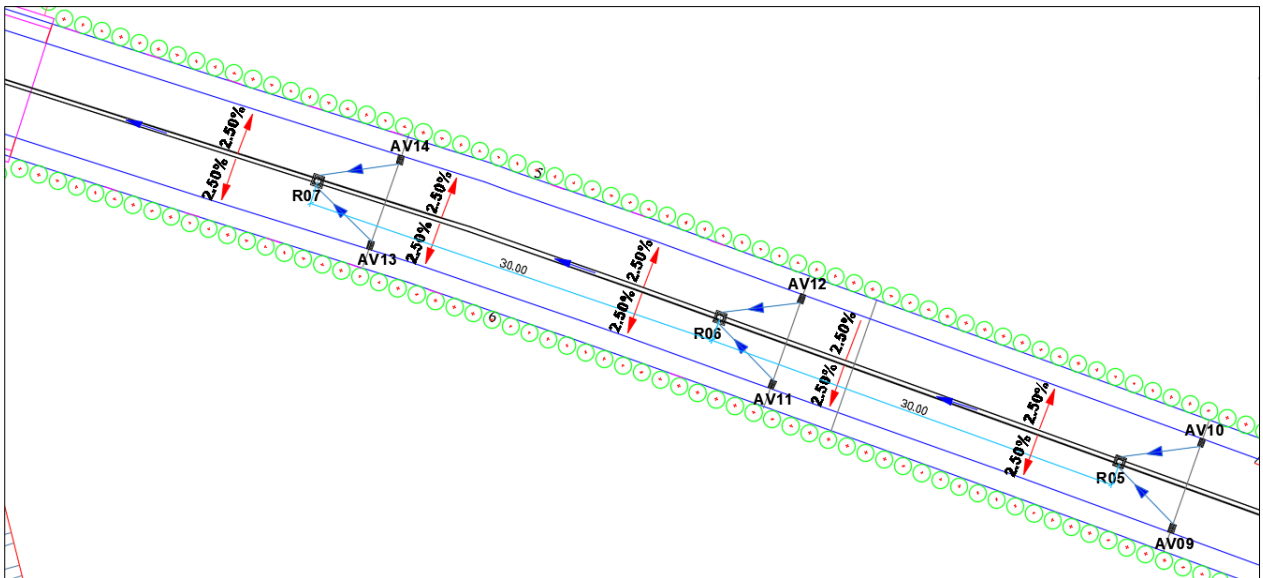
Plan d'assainissement de la partie ouverte – vers Bahli –
